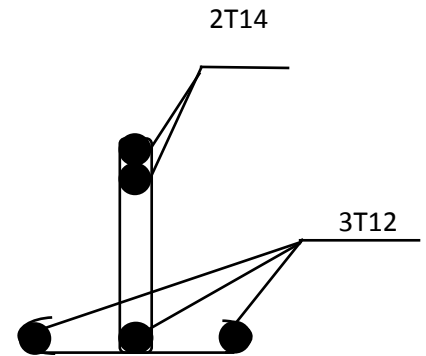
Schéma de ferrailage de la section en T (Terrasse)
